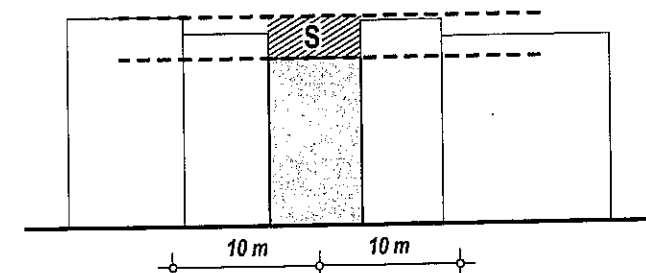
Surélévation d'une façade sur rue ou immeuble neuf
